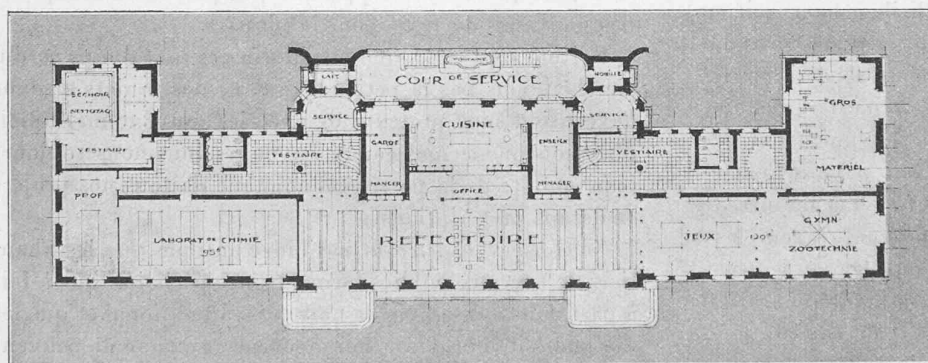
Plan du 2<sup>e</sup> étage. — 1 : 600.Fig. 16. — Plan du 1<sup>er</sup> étage. — 1 : 600.
